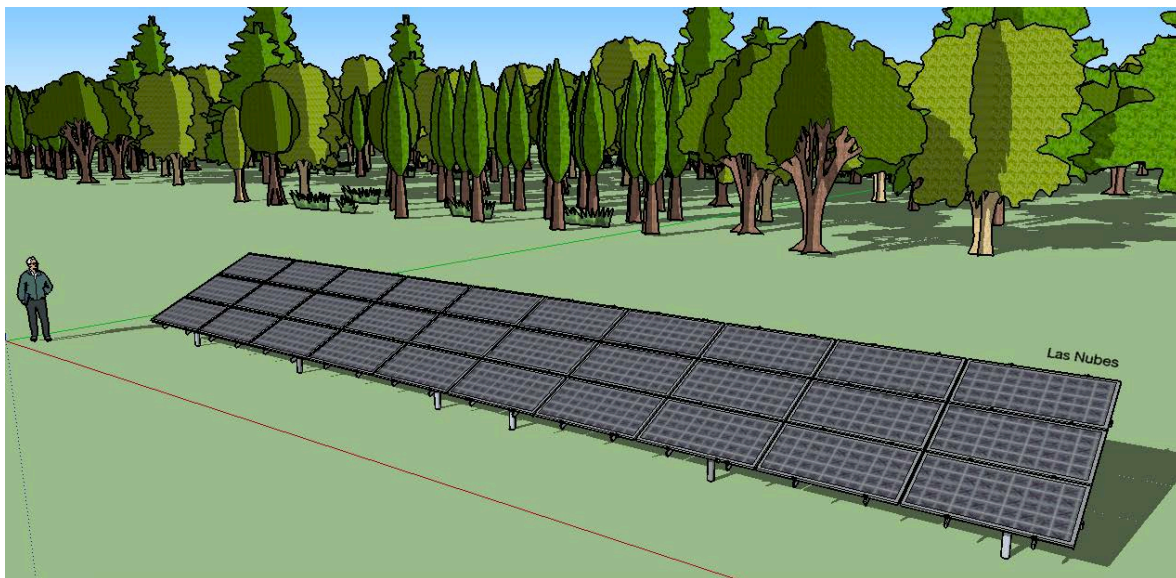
Modelo 3D de la instalación fotovoltaica de la planta de verificación
